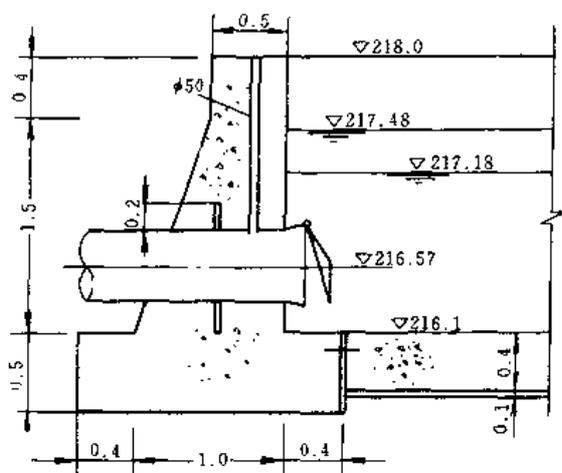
出水池挡水墙断面尺寸示意 (单位: m)
